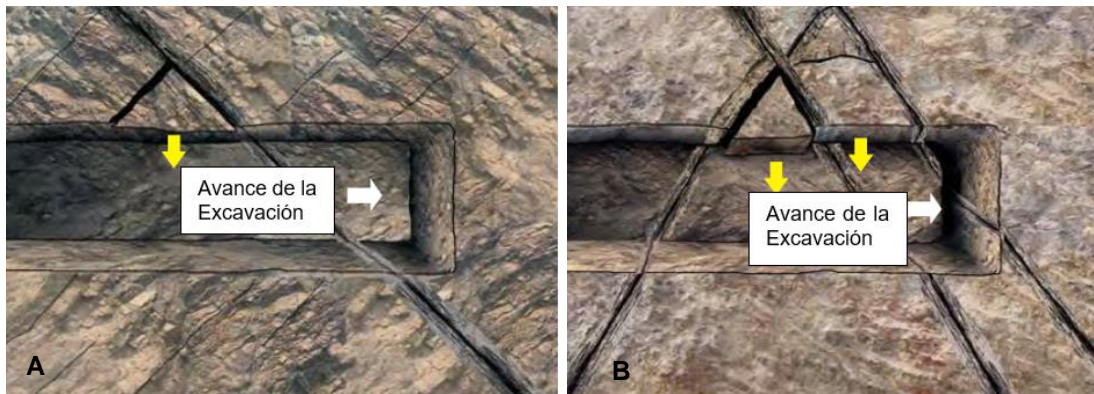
A: Falla como estructura aislada; B: Fallas como estructuras múltiples.
